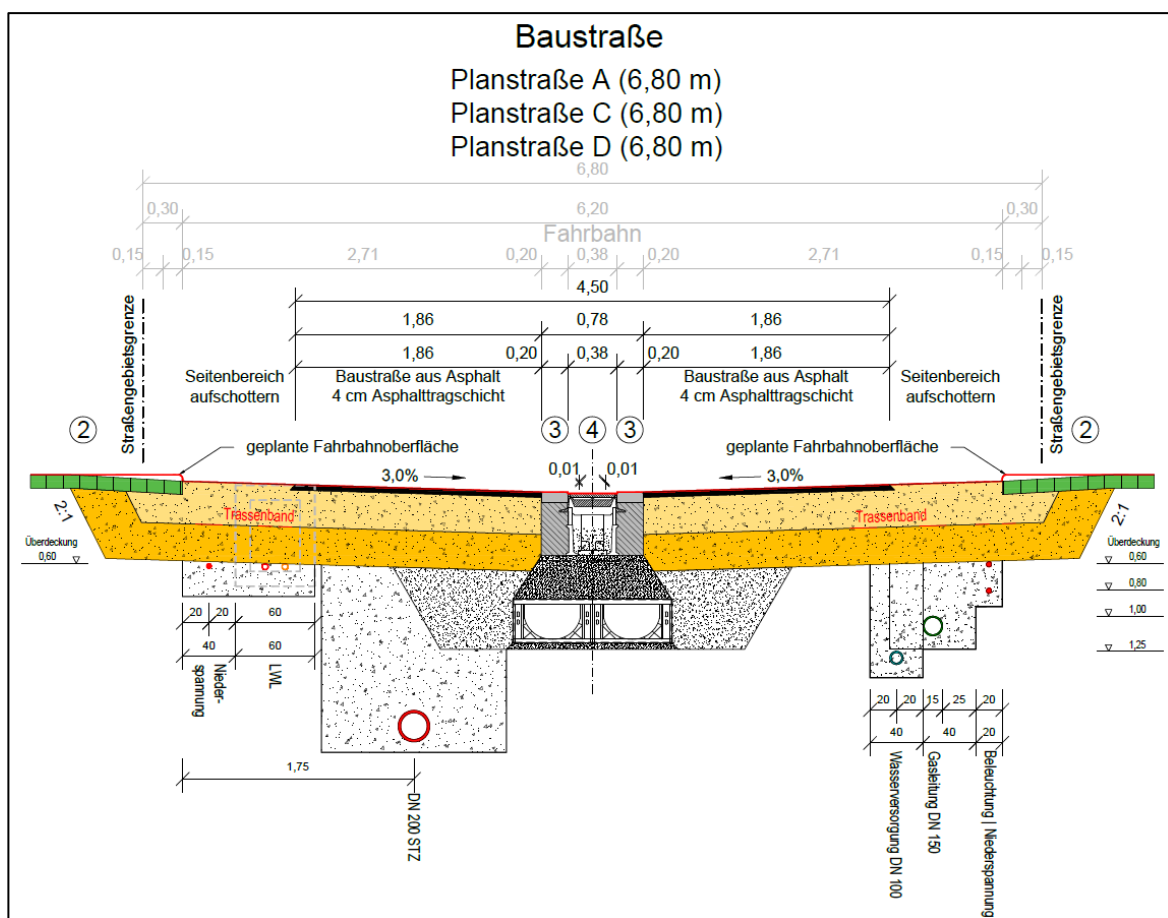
Straßenschnitt Planstraße; Quelle: Bauentwurf Erschließungsplanung Bebauungsplan Nr. 98 Stadt Bad Segeberg, GSP Ingenieurgesellschaft mbH Dezember 2022
